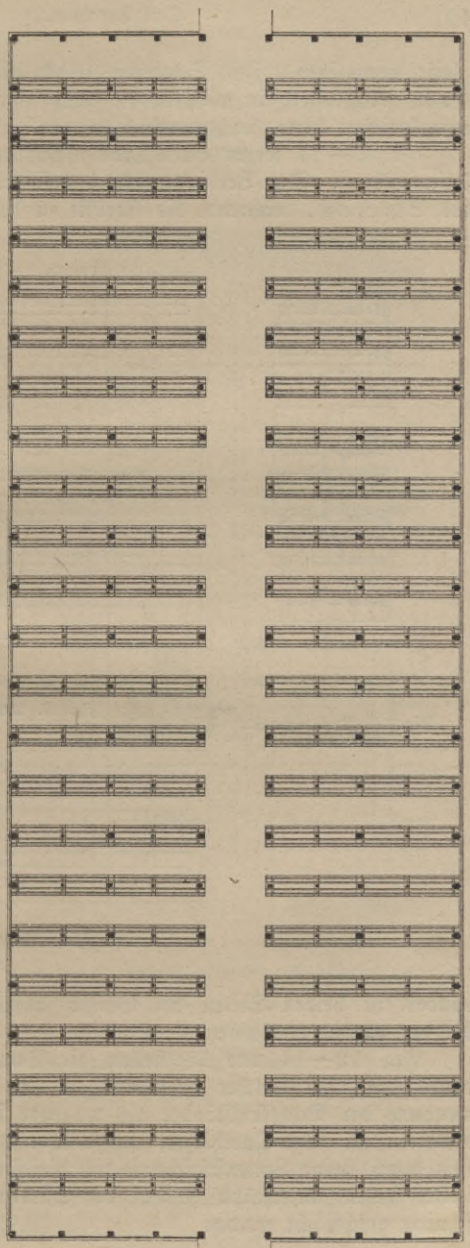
Trockenschuppen, 20 m breit. Grundriß.
